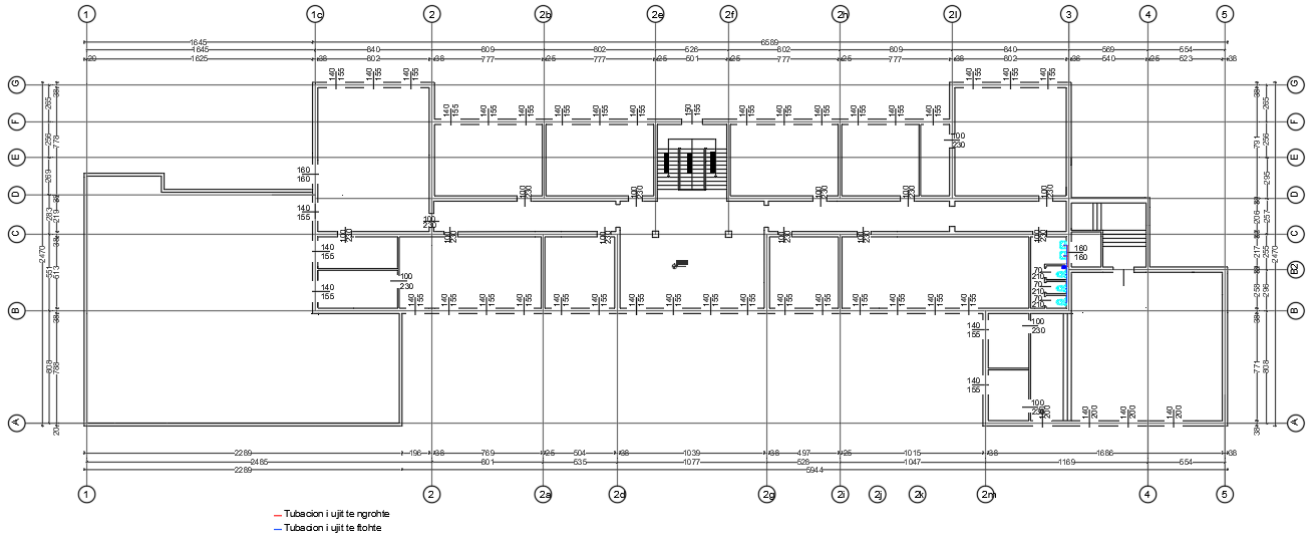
Planimetria e instalimeve hidraulike, kati i dyte
